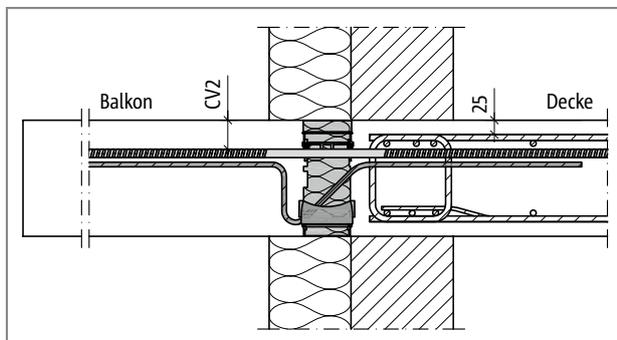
Schöck Isokorb® CT Typ KL-CV2: Anschluss bei deckengleichem Unterzug
